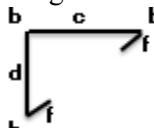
32 Detail Tulangan Memanjang Bawah Tangga c
